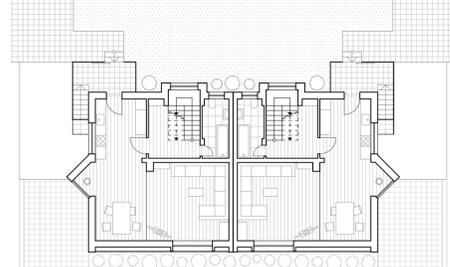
Grundriss Erdgeschoss M 1:200
